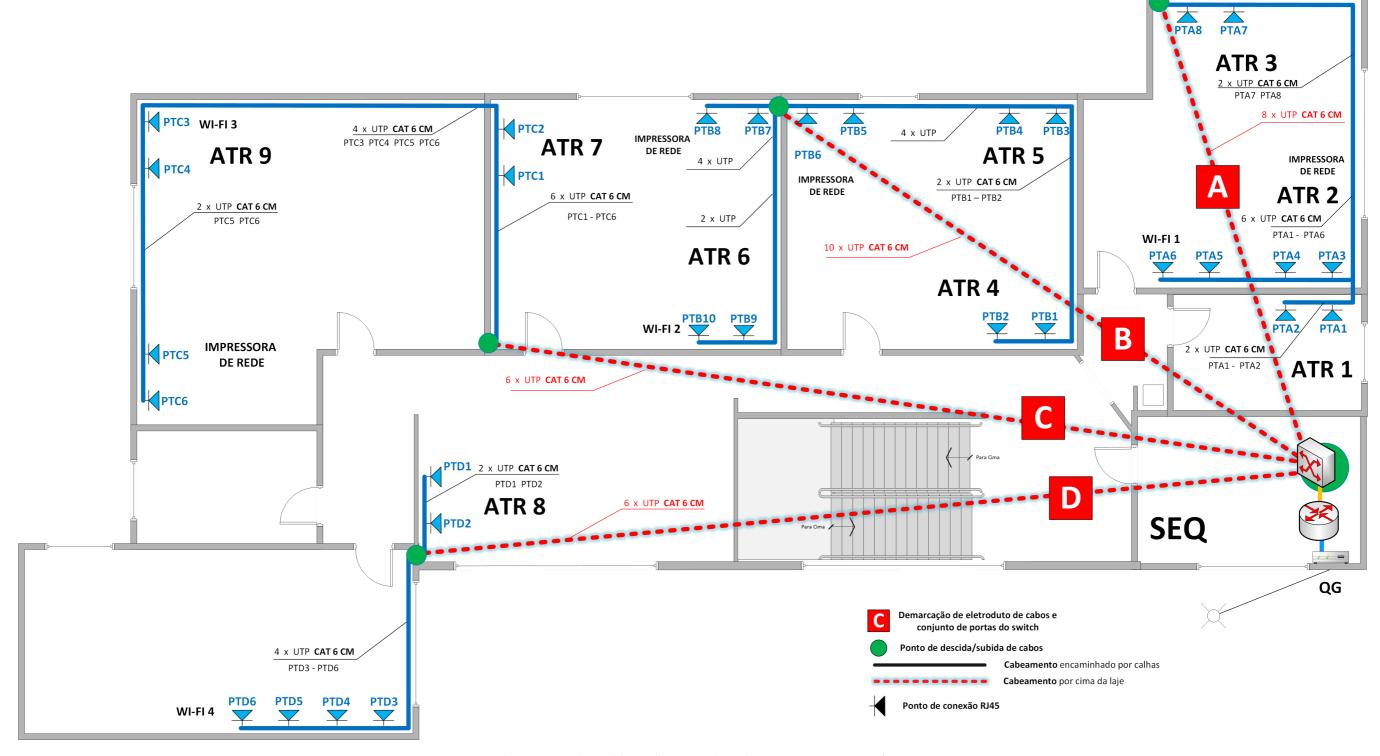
Planta lógica da visão do cabeamento - Formato A3
